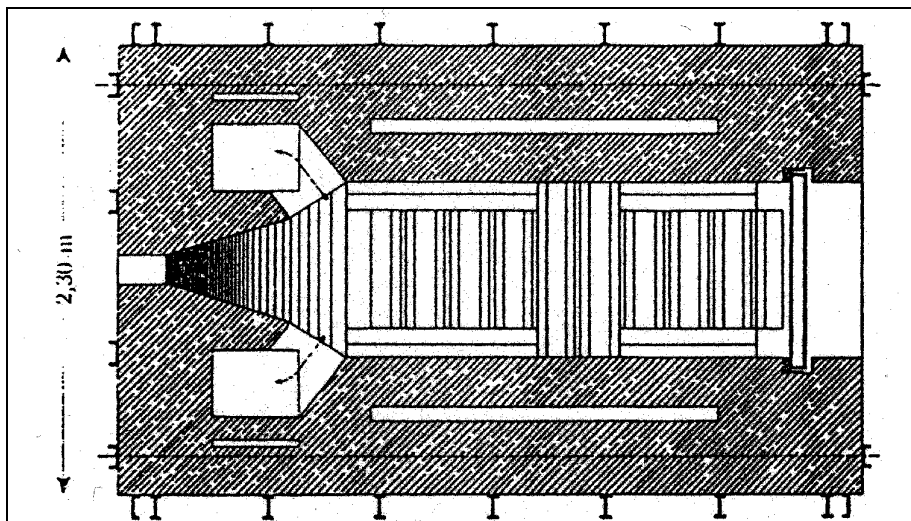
Grundriß A—B durch den Einäscherungsraum.
